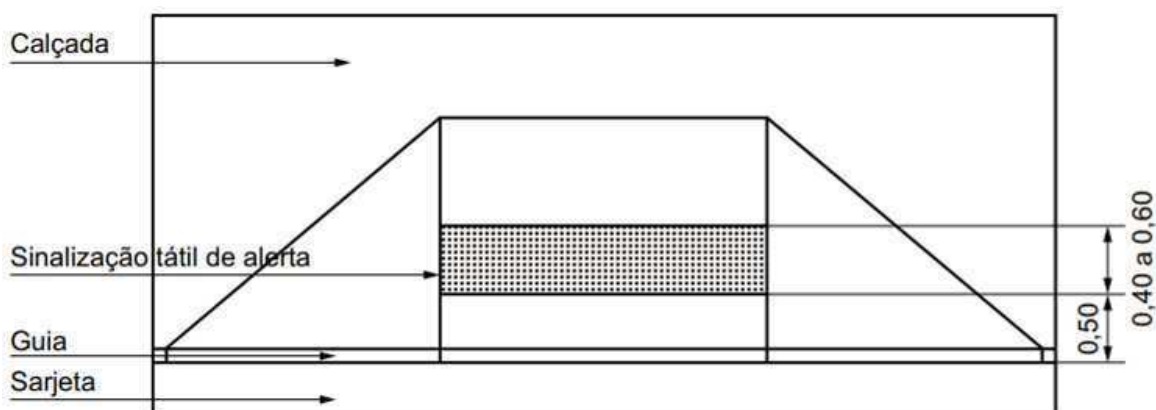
Rebaixo de calçada com rampas com inclinação entre 5,00 e 8,33%
